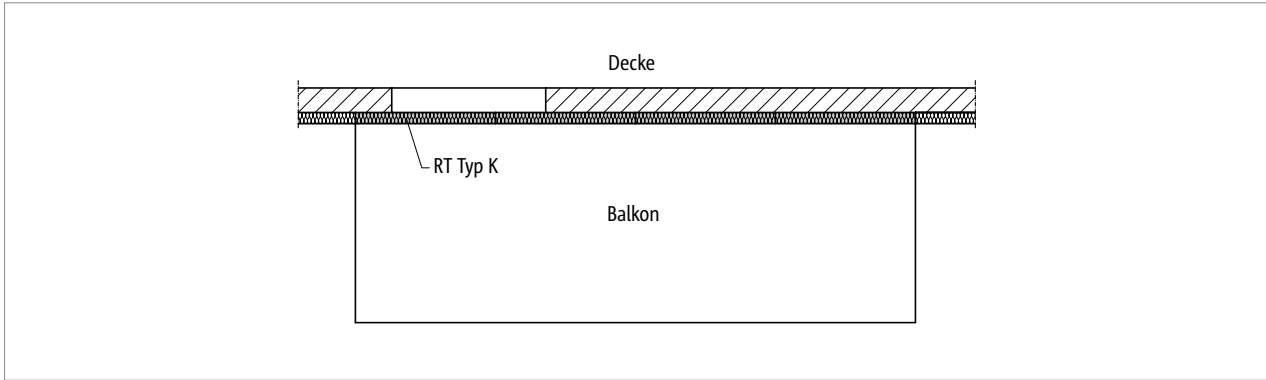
Schöck Isokorb® RT Typ K: Balkon frei auskragend bei Erneuerung eines Bestandsbalkons
